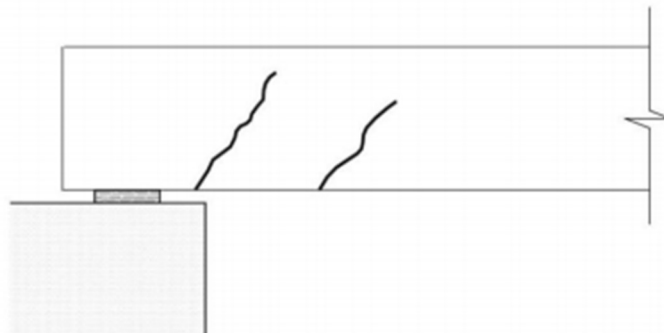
Desarrollo de fisuras por corte
